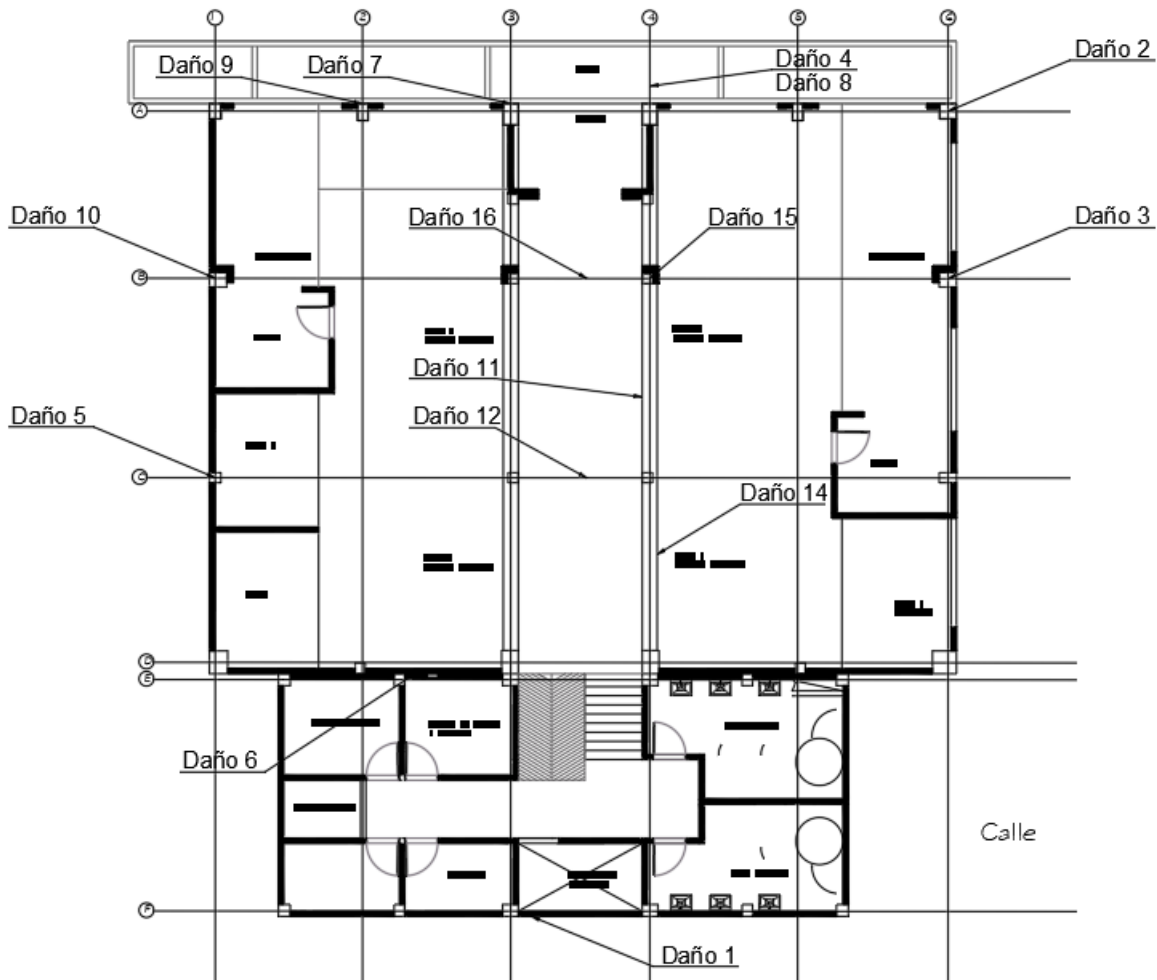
Localización de daños planta primer piso. Fuente: Propia
